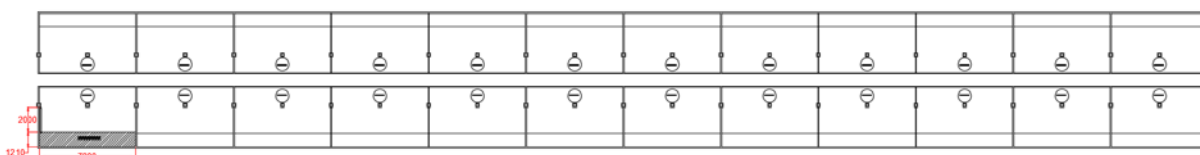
Planta baixa da unidade de terminação com as 24 baias
